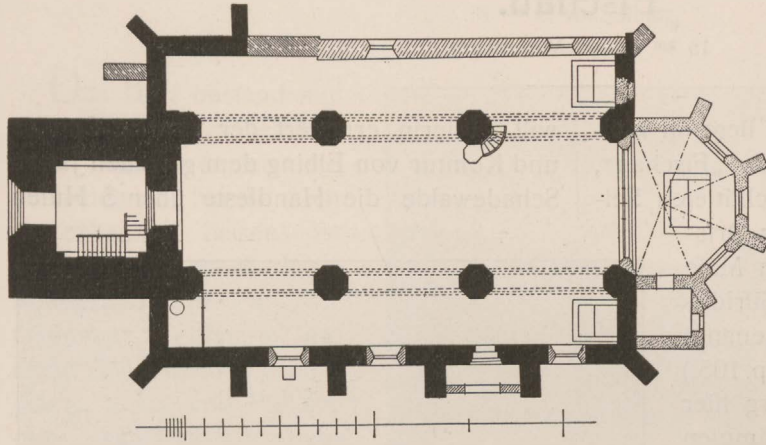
Grundriß der kath. Pfarrkirche in Fischau. Maßstab 1 : 400.
